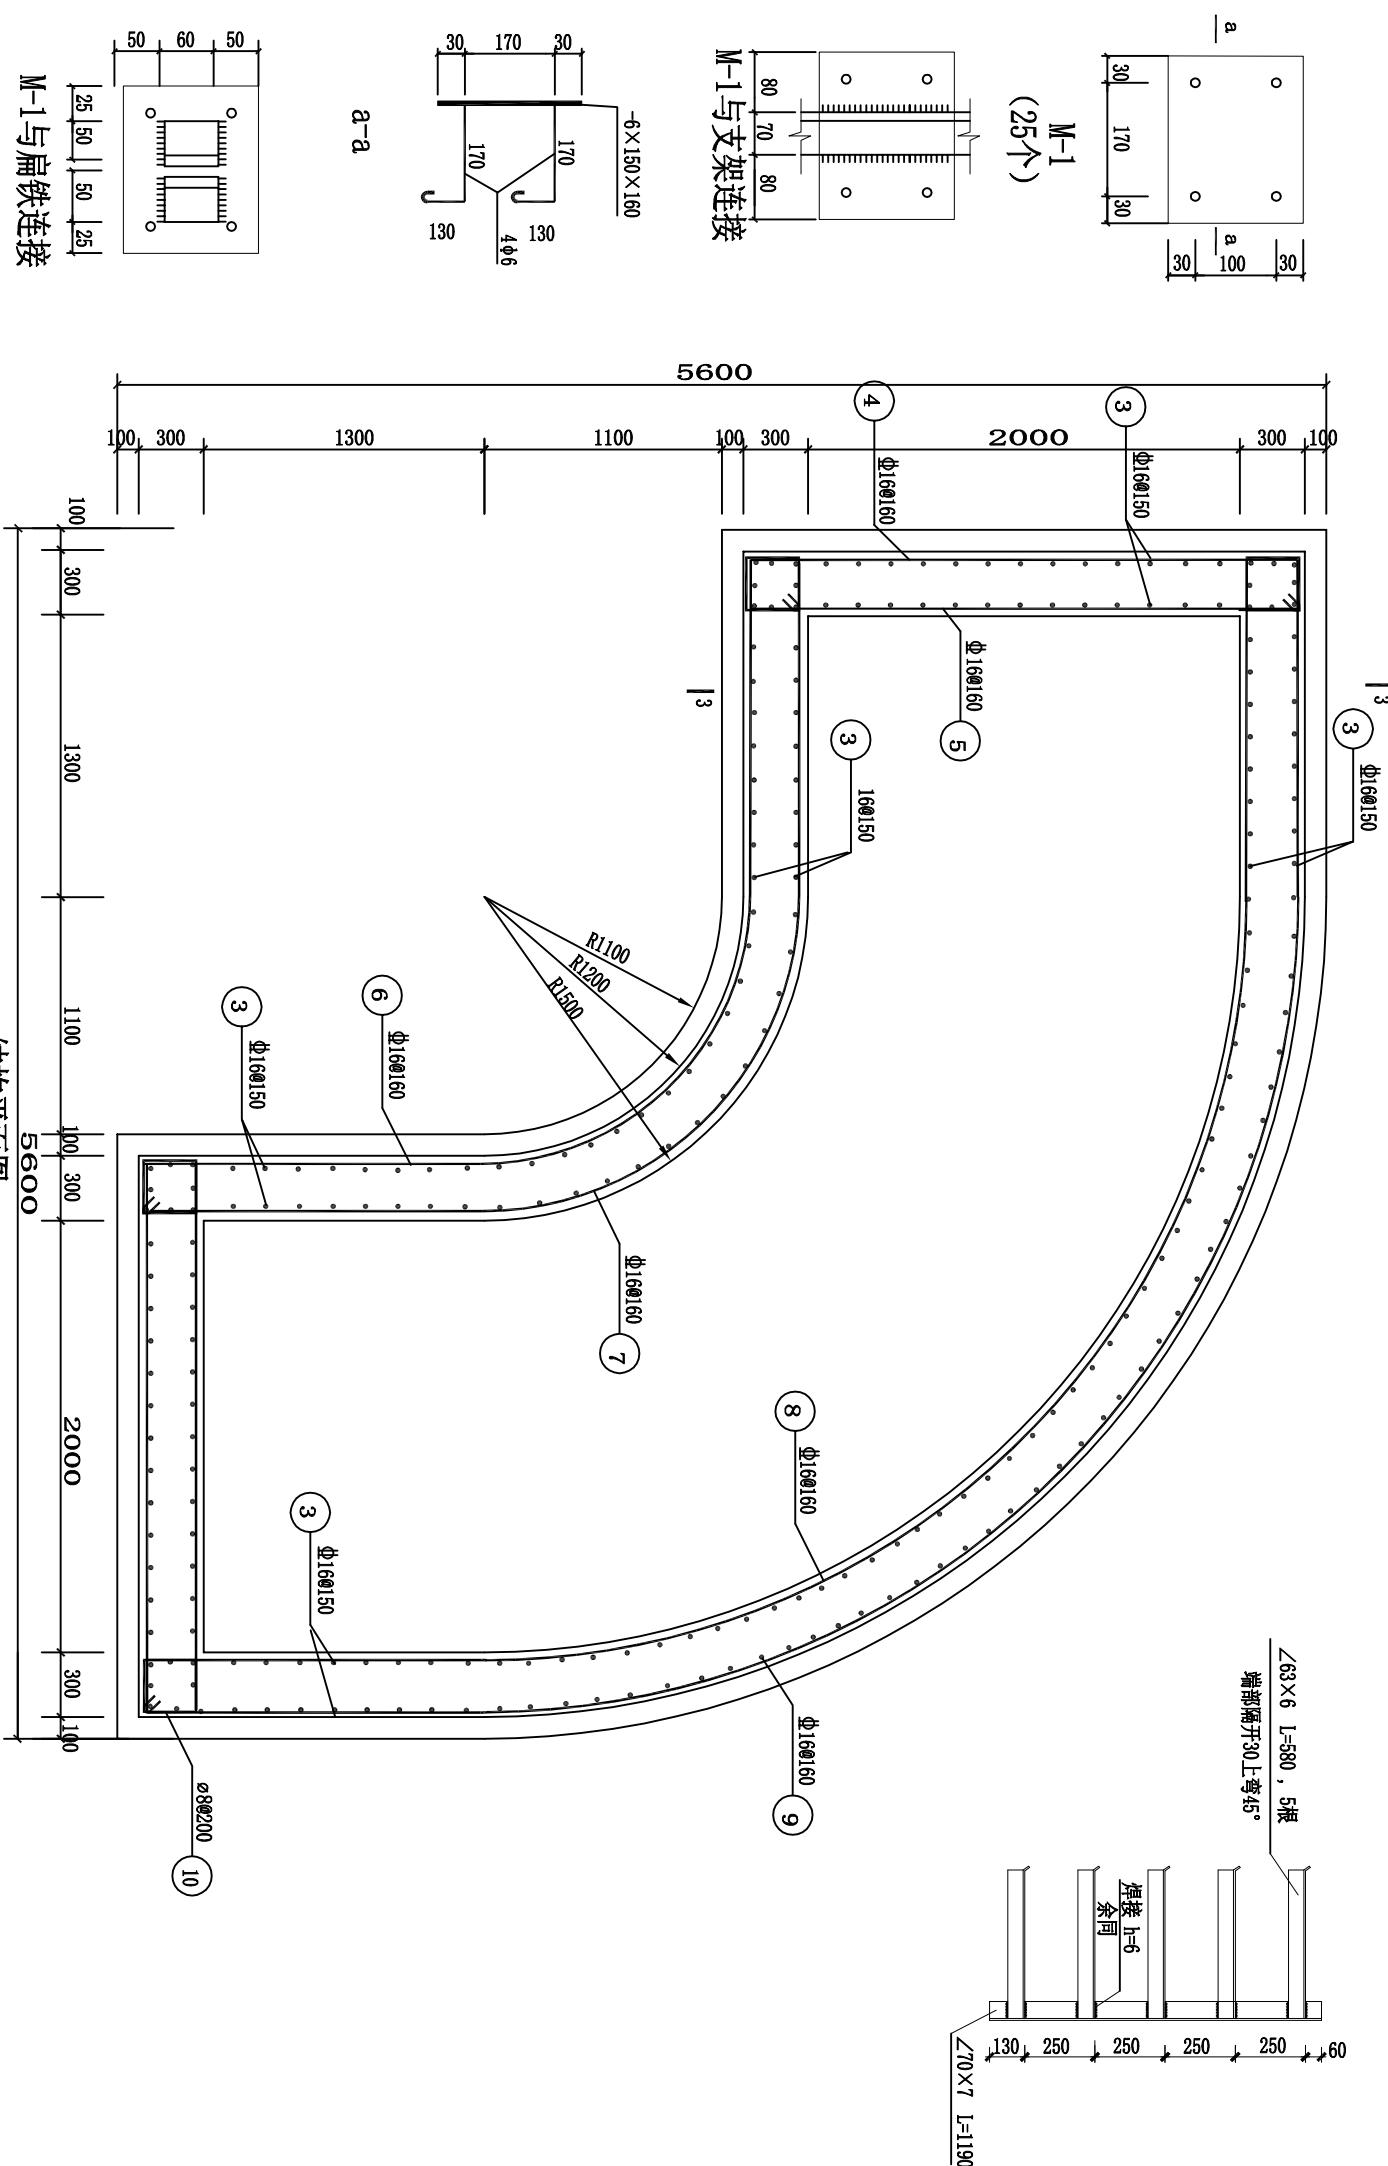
[(6.0~10.0)×2.0×1.9] 钢筋混凝土转弯电缆井 (E-2-5) (三)
